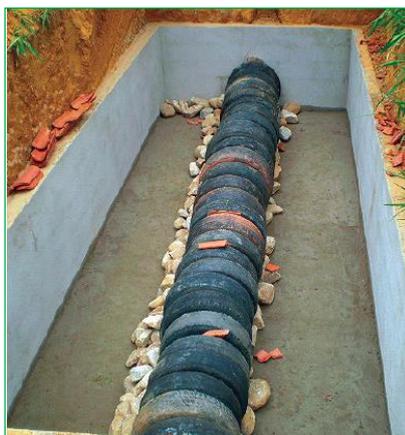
BET – Trincheira impermeabilizada e câmara de digestão montada.
